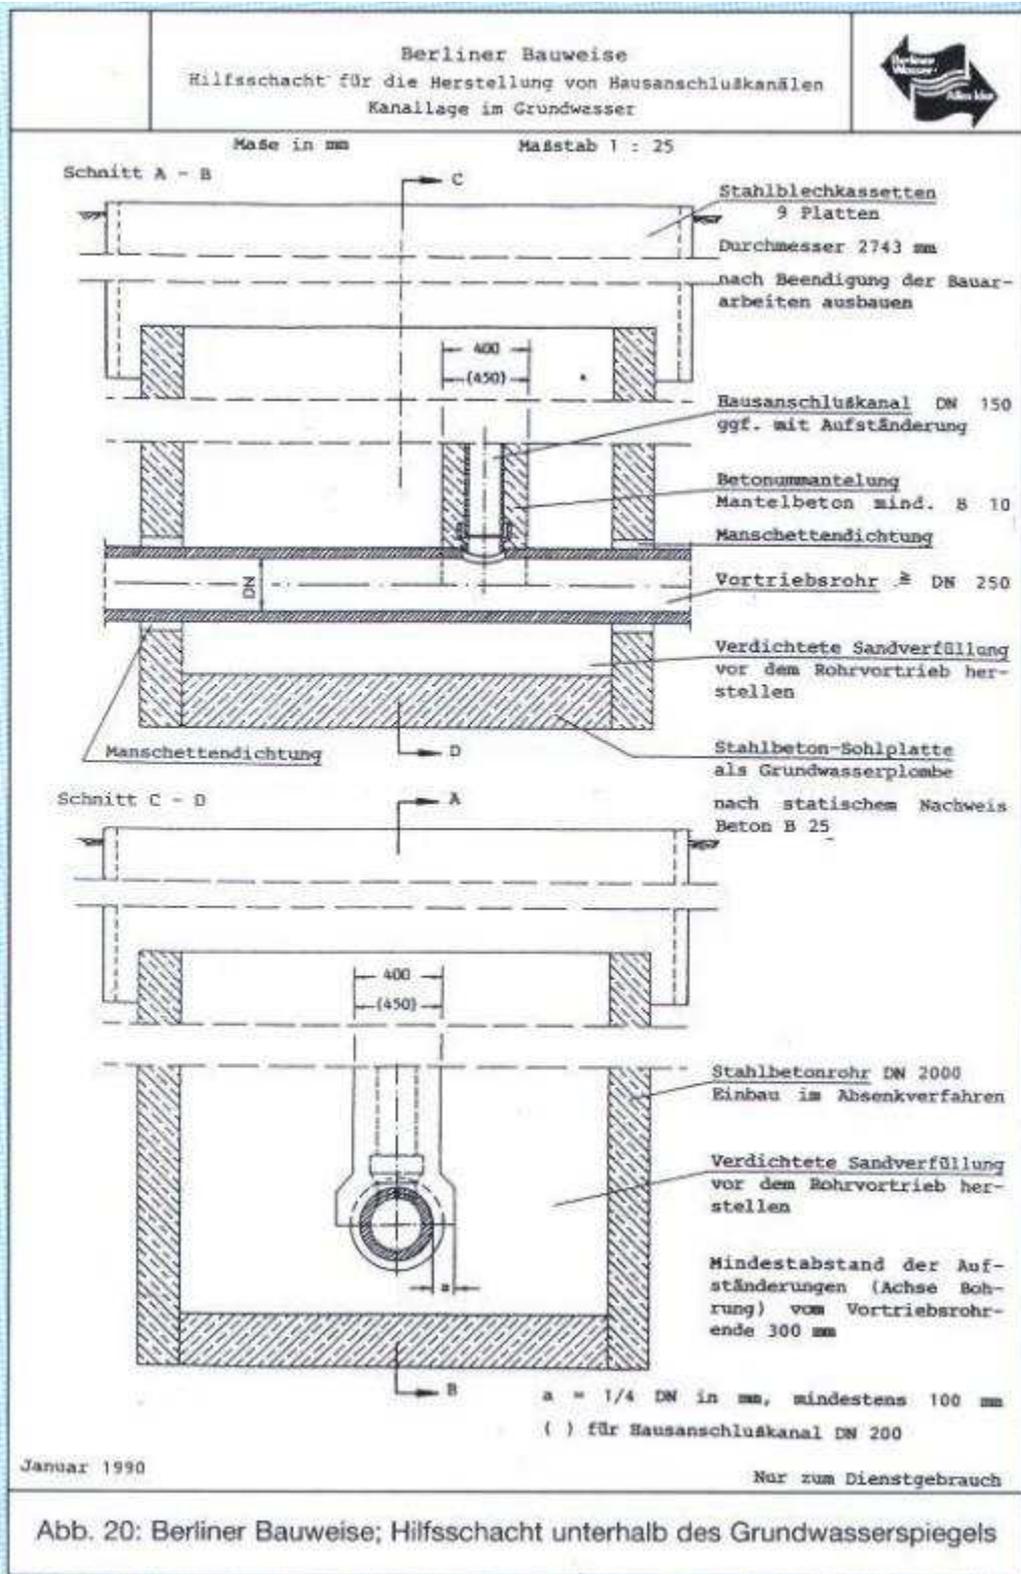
Berliner Bauweise; Hilfsschacht unterhalb des Grundwasserspiegels
